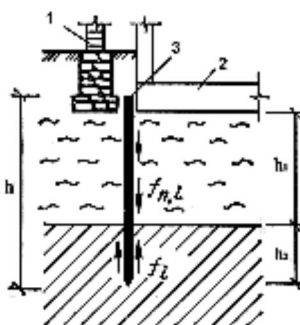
Роз'єднувальна шпунтова стінка: 1 – фундамент існуючої будівлі; 2 – фундамент споруджуваної будівлі; 3 – роз'єднувальний шпунт
